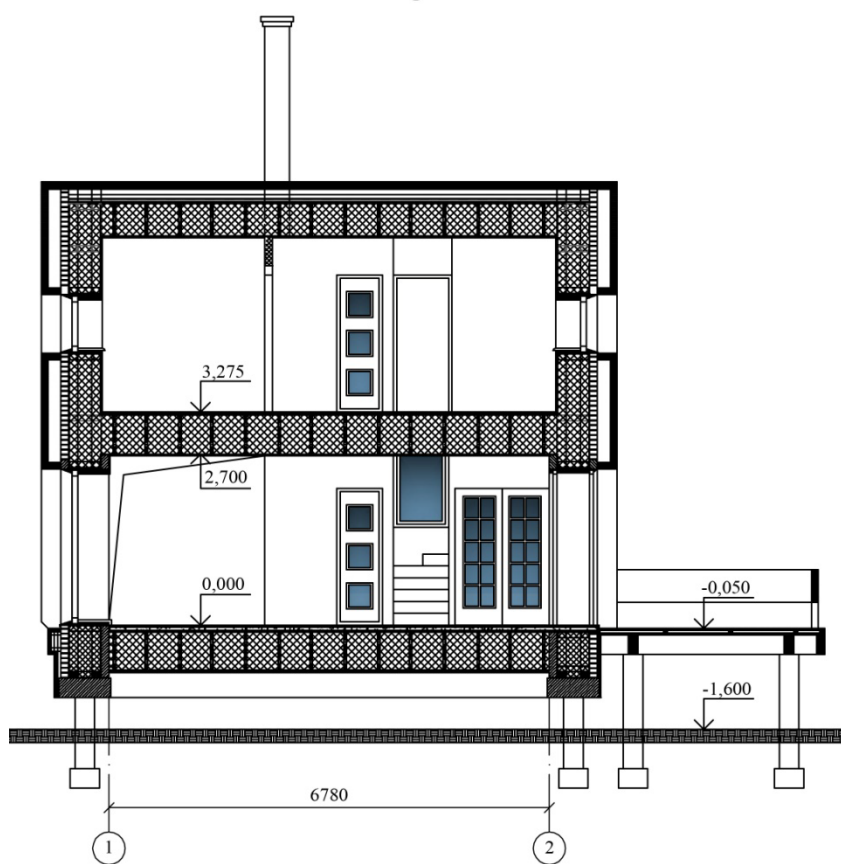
Екологічна будівля «потрійний нуль». Розріз 2-2
